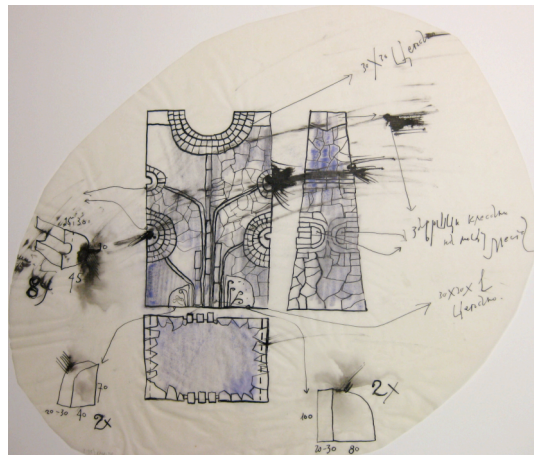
Ansichten, Grundriss und Details für Vlasotince, um 1975
